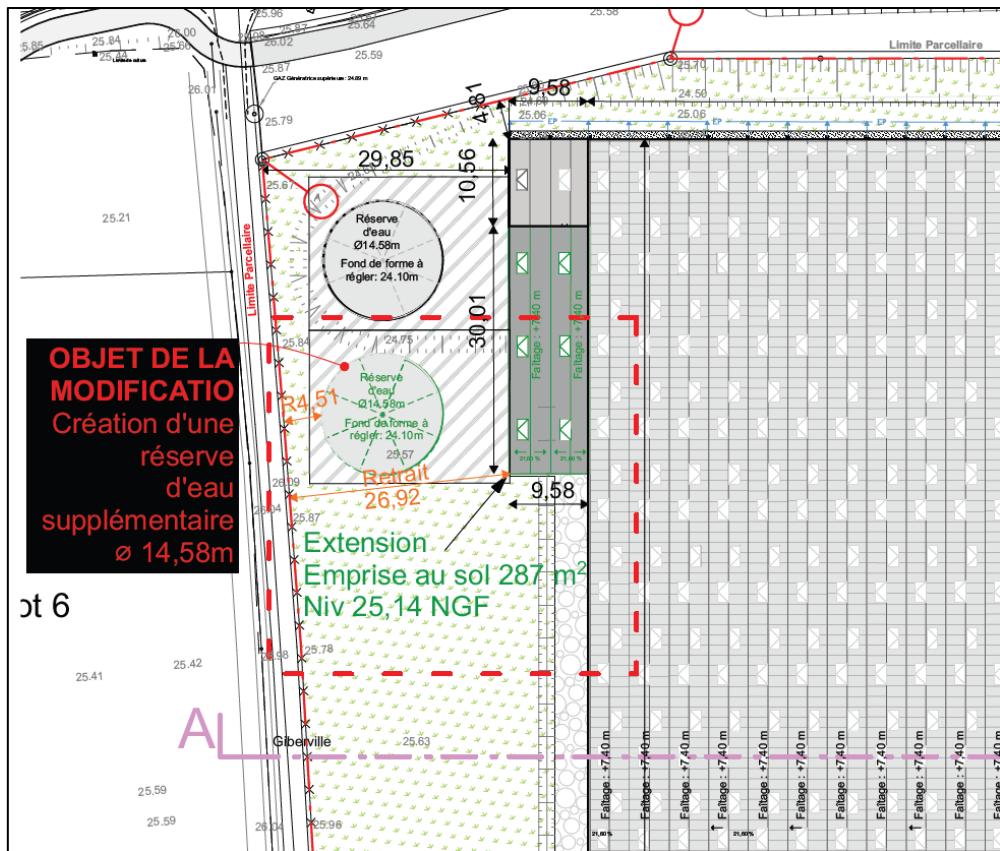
Plan du projet PC 014 167 24 P0006 M01 (source : plan de masse)
